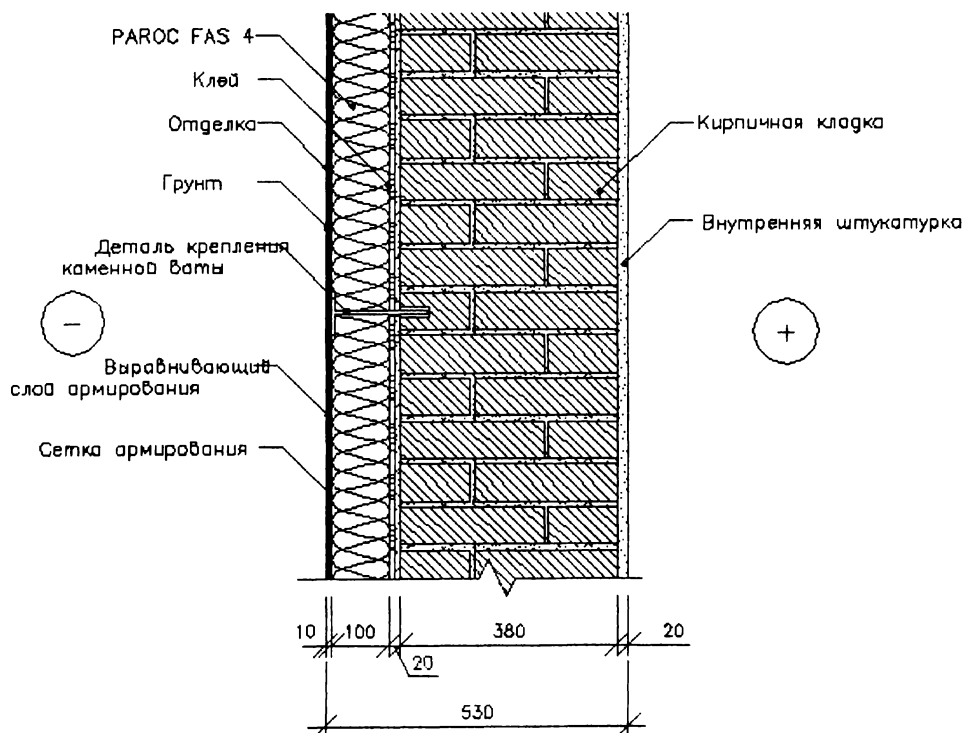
Утепление стены кирпичной кладки, применяя для системы плиту FAS 4
